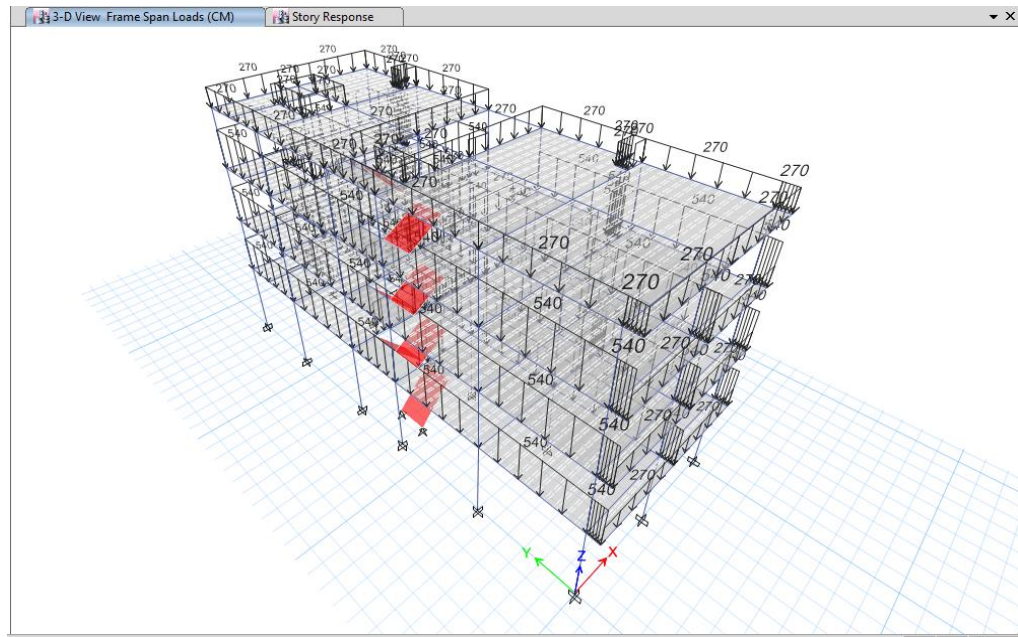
Carga distribuida en vigas por tabiquería en unidad tonf.
